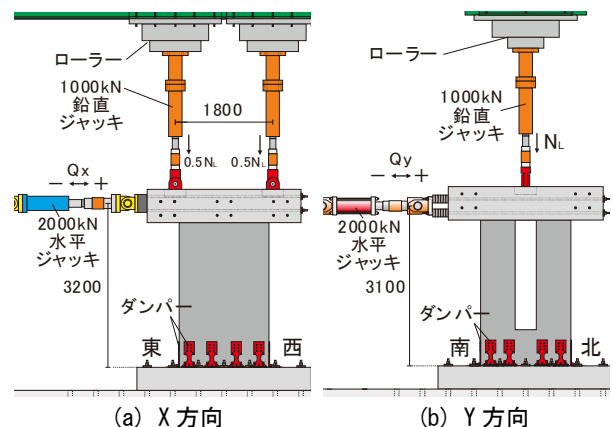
載荷装置図（実験Ⅳの場合、単位：mm）
